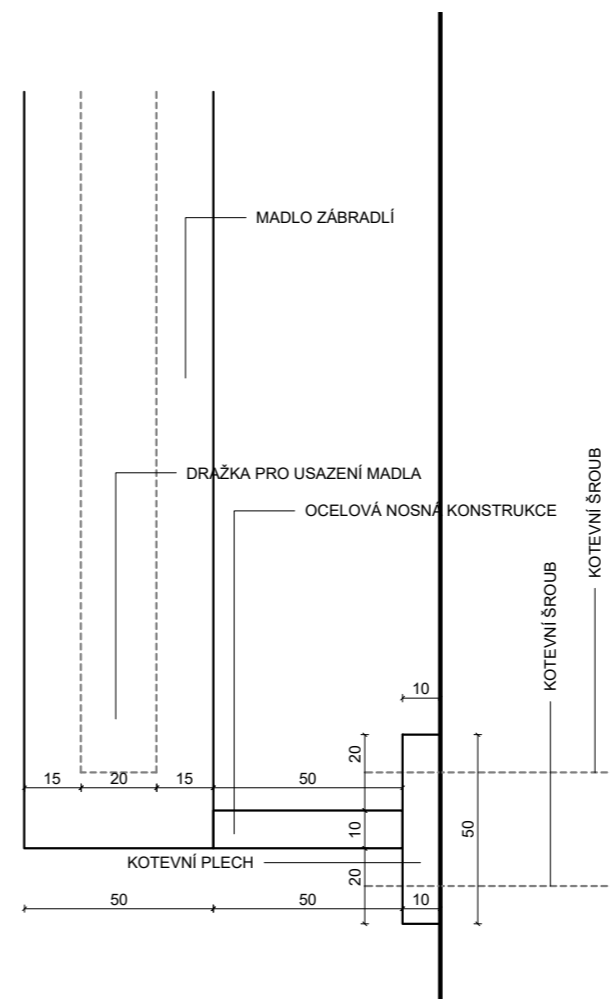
DETAIL UKOTVENÍ MADLA K STĚNĚ POHLED Z BOKU
